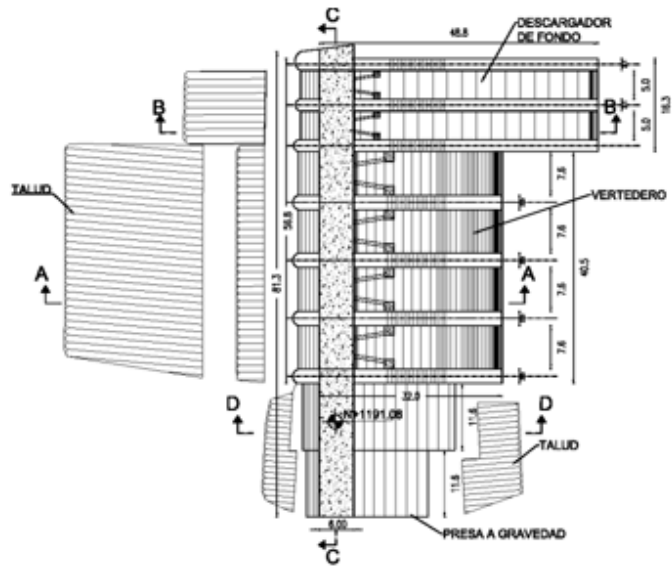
7 Vista en planta eje 1 (Fuente EUPRO)
